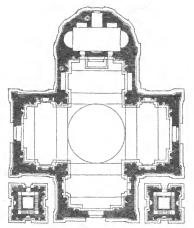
Madonna di S. Biagio zu Montepulciano. Grundriss. (Nach Laspeyres.)
